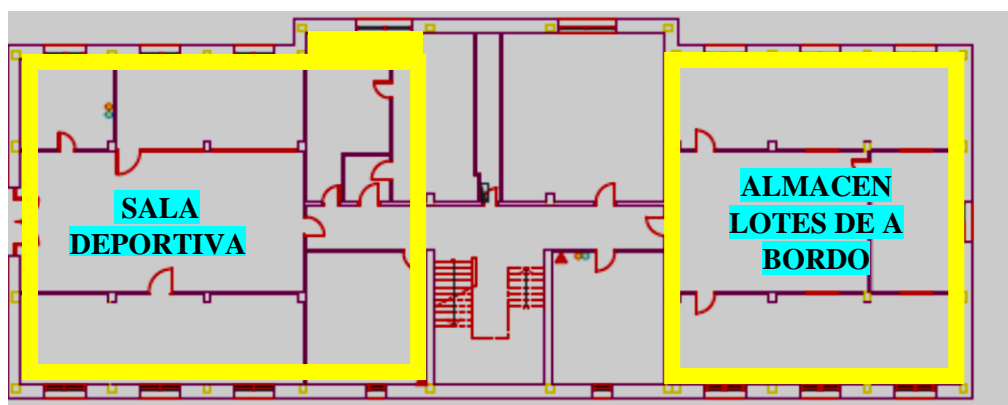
Plano sótano. Fuente: Elaboración propia (plano del plan de mantenimiento 2019)
